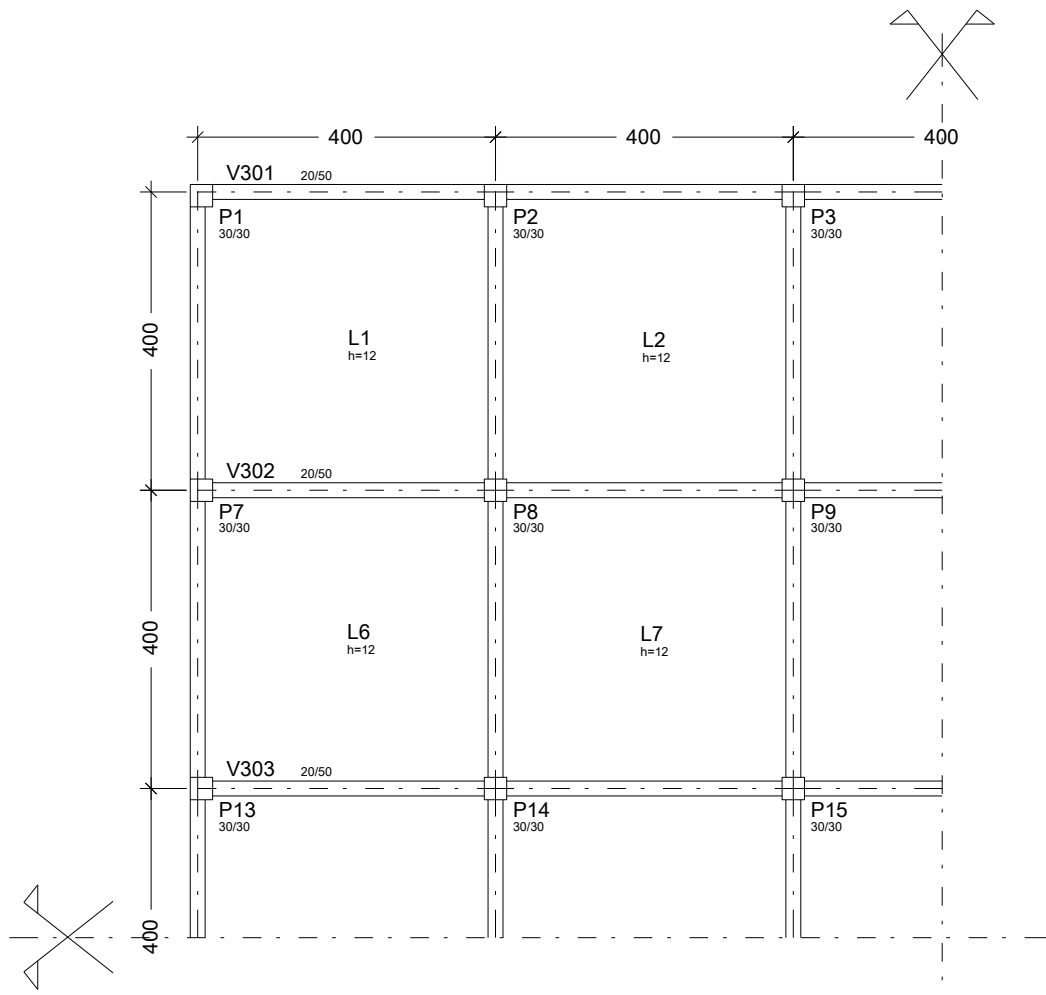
Detalhe em planta do Edifício Exemplo, dimensões em centímetros
